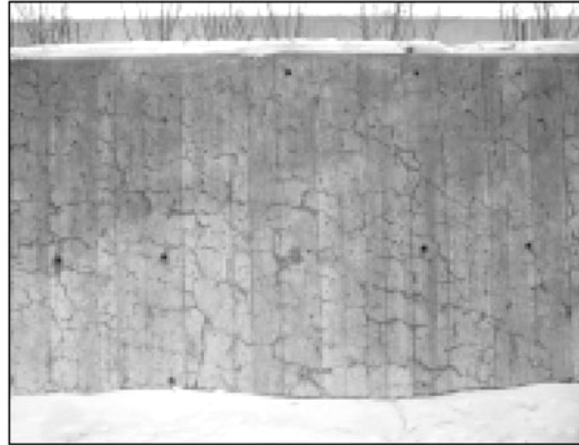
Fissuration caractéristique en faïençage causée par la réaction alcalis- silice dans un mur de soutènement à Ottawa
